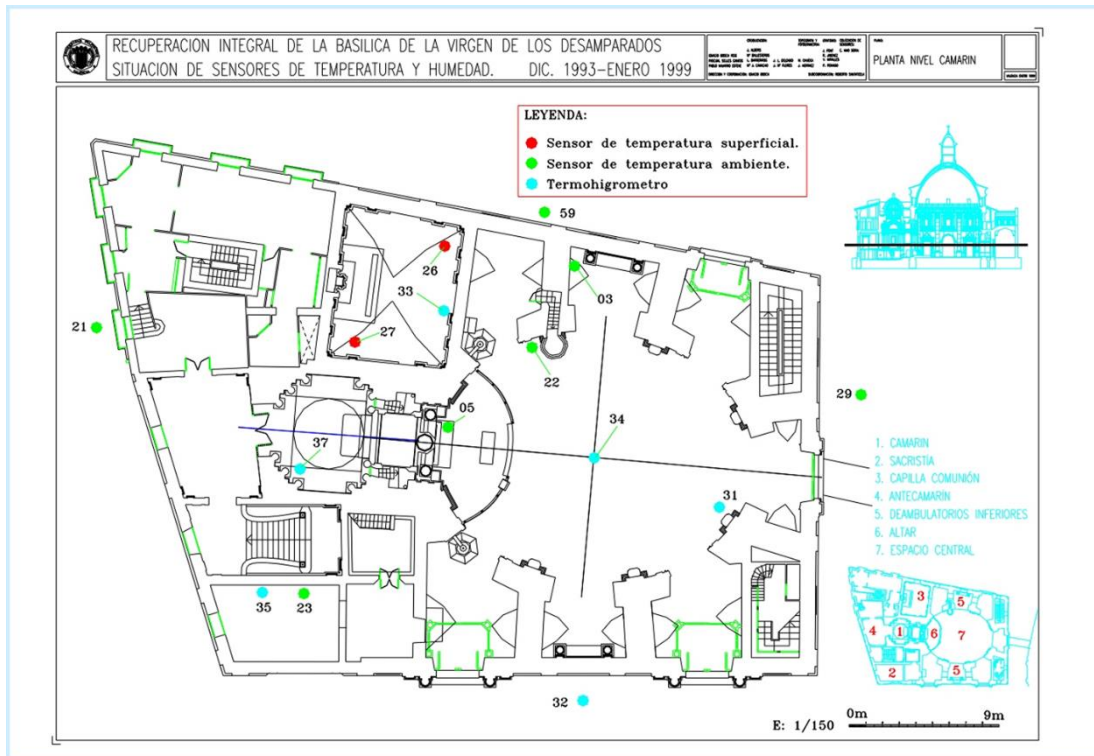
Situación de sensores. Planta nivel Camarín.
